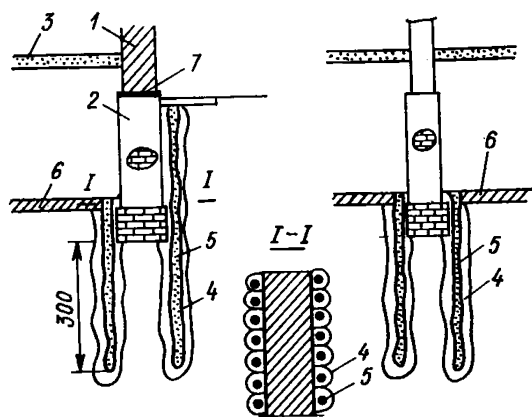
Усиление оснований фундаментов часторасположенными буровыми набивными сваями малого диаметра
